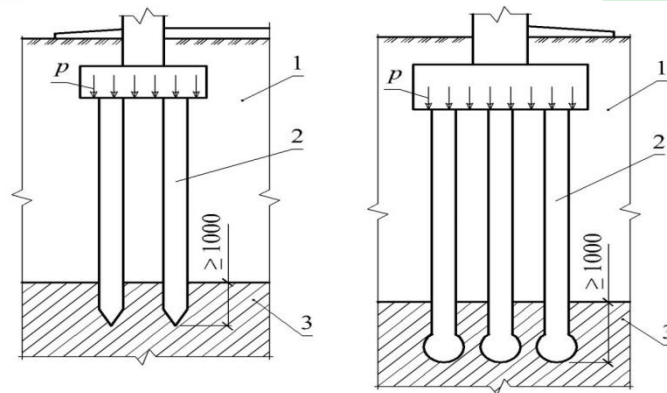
Схемы устройства свайных фундаментов из свай, прорезающих просадочную толщу основания: а, б – соответственно забивные сваи, буронабивные сваи с уширением, 1 – лессовый просадочный грунт, 2 – сваи; 3 – непросадочный грунт
